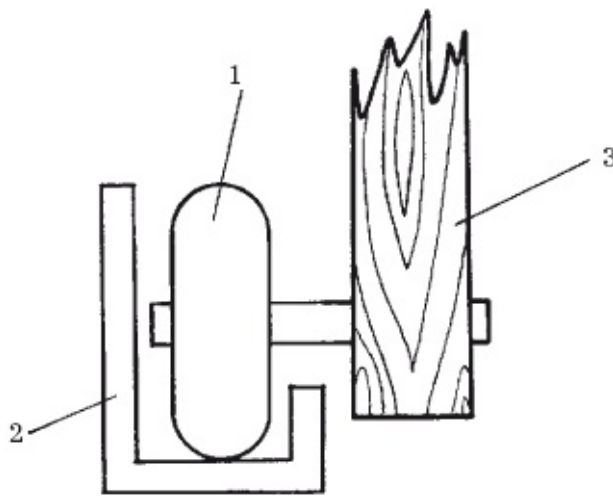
Схема крепления нижних роликов раздвижной двери: 1 – ролик; 2 – профиль; 3 – дверное полотно
